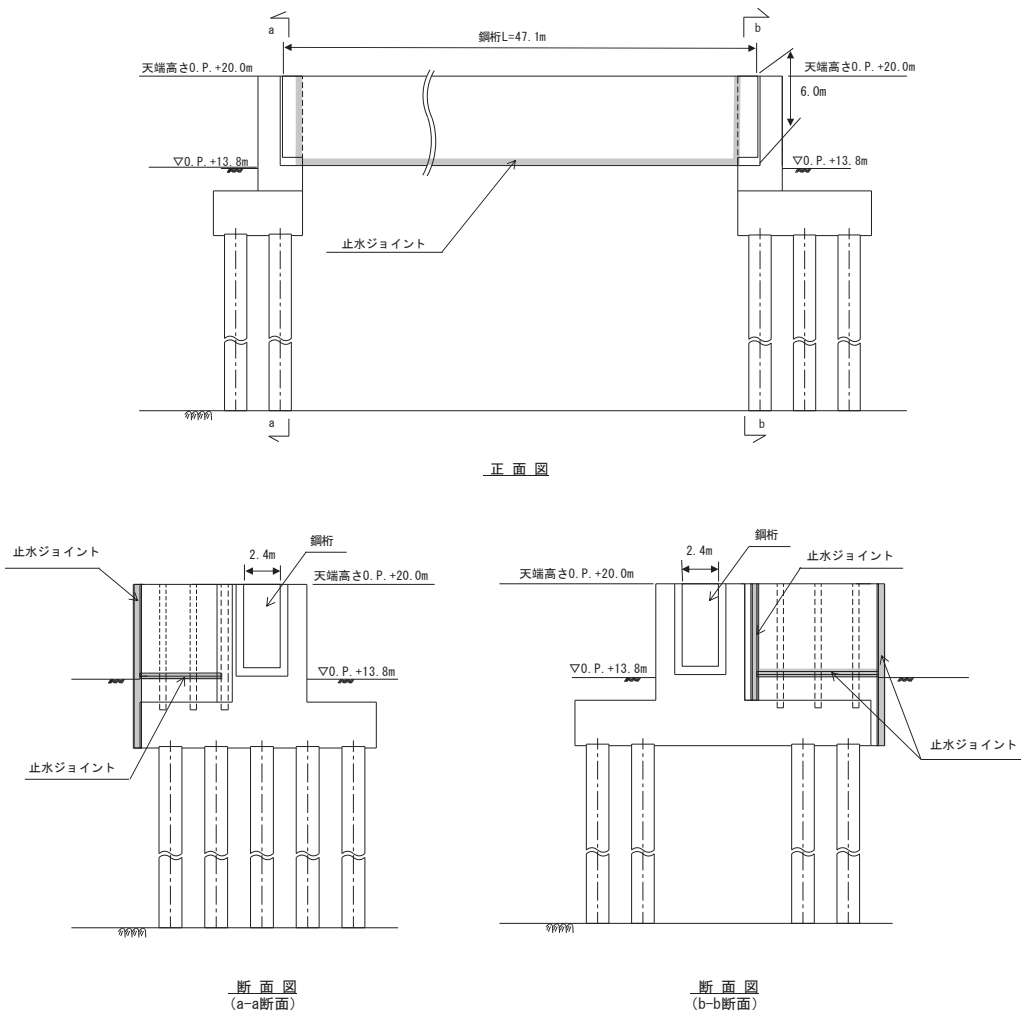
鋼製遮水壁（鋼桁4） 正面図及び断面図
